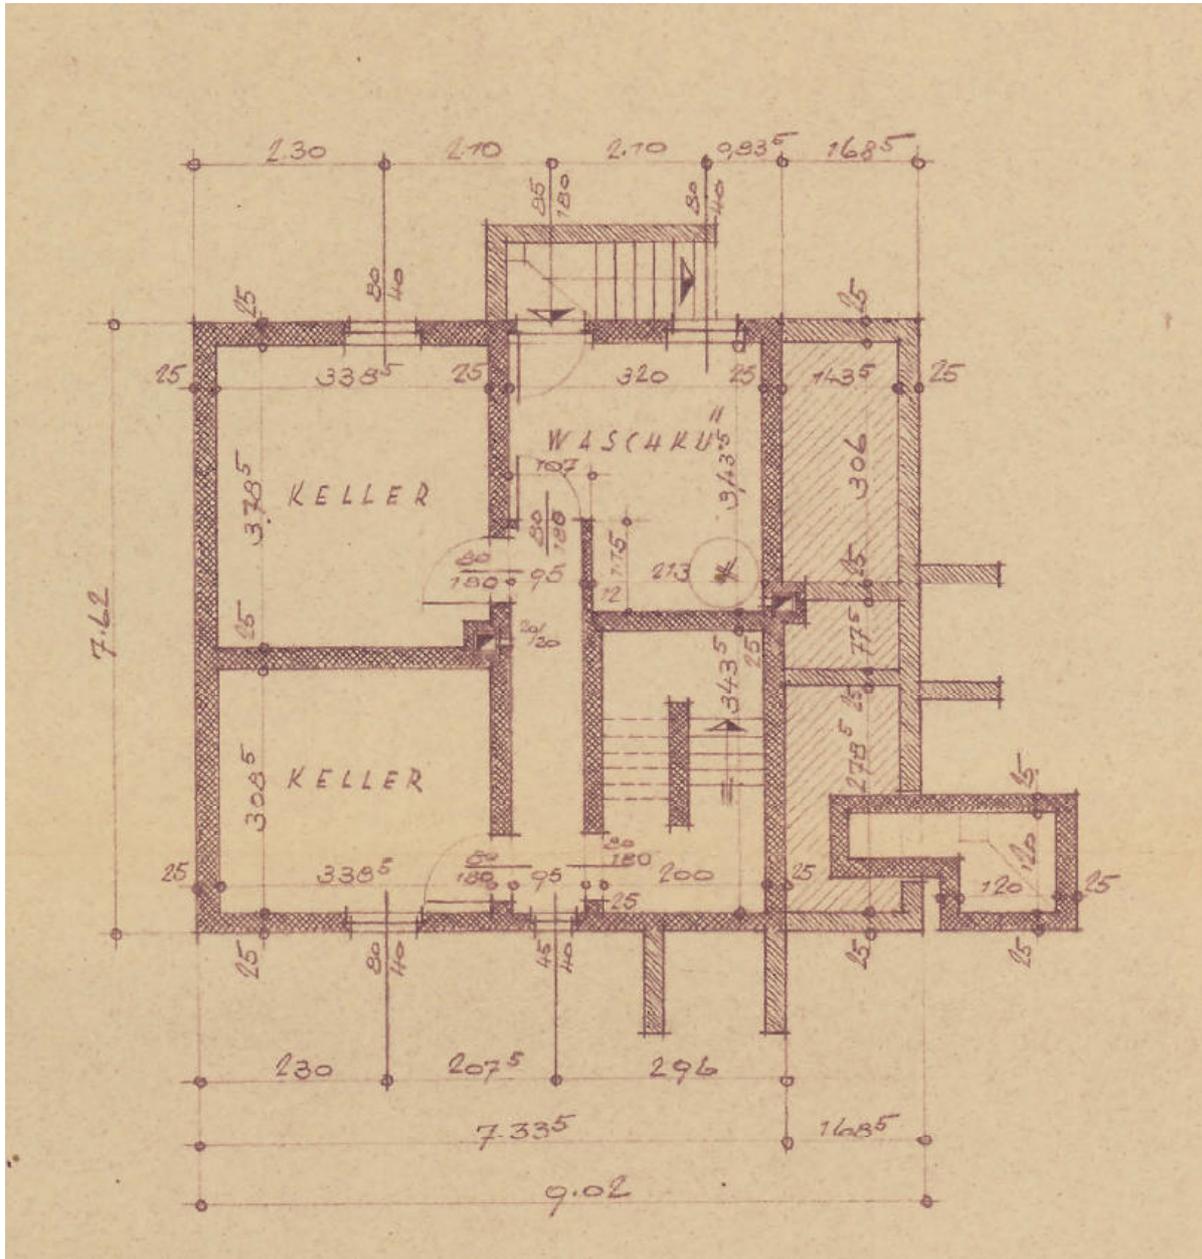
Kellergeschoss / Plan aus der Bauakte Abweichungen vor Ort sind möglich
